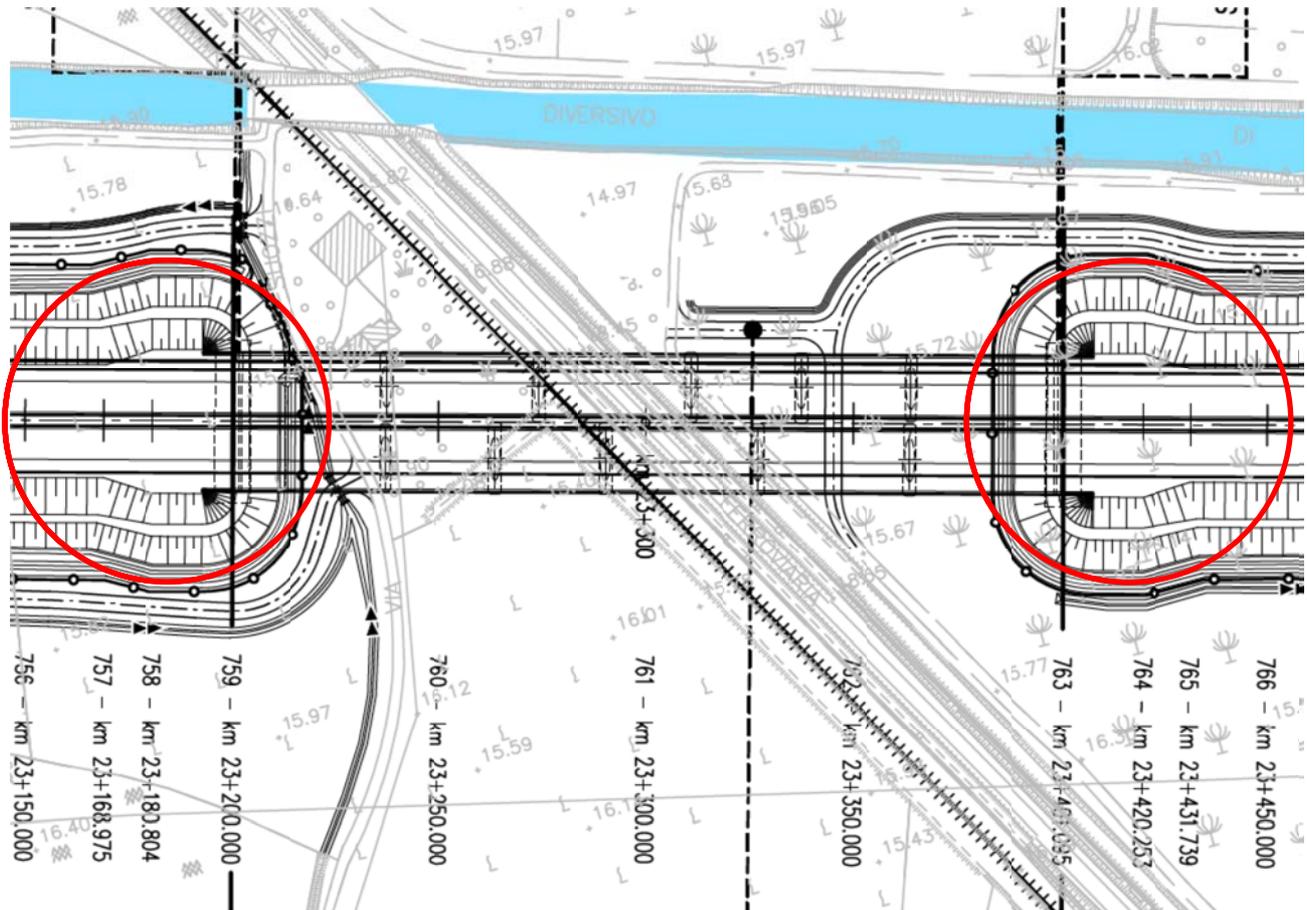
ESEMPIO ALLARGAMENTO RILEVATO IN CORRISPONDENZA VIADOTTO
